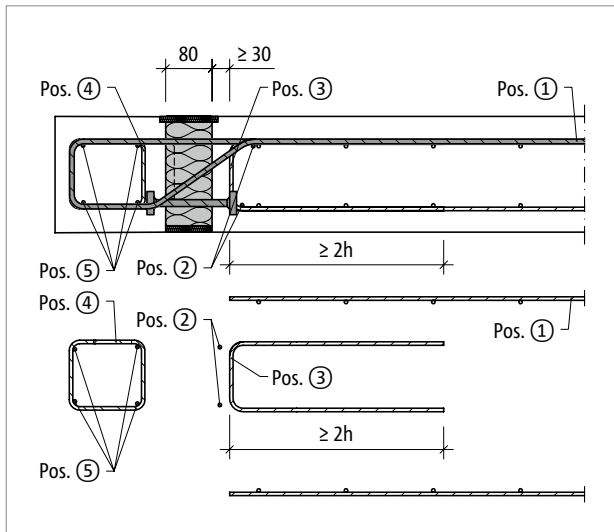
Schöck Isokorb® T Typ OP: Bauseitige Bewehrung
